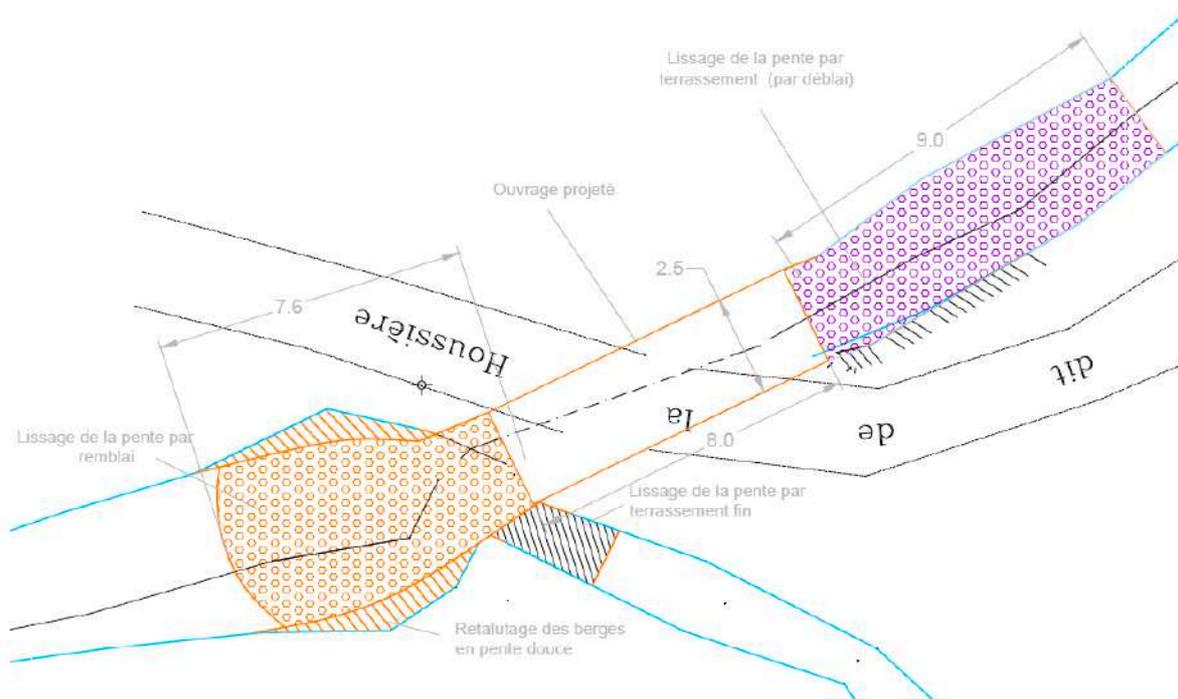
Vue en plan de l'aménagement de l'ouvrage ROE 114687
